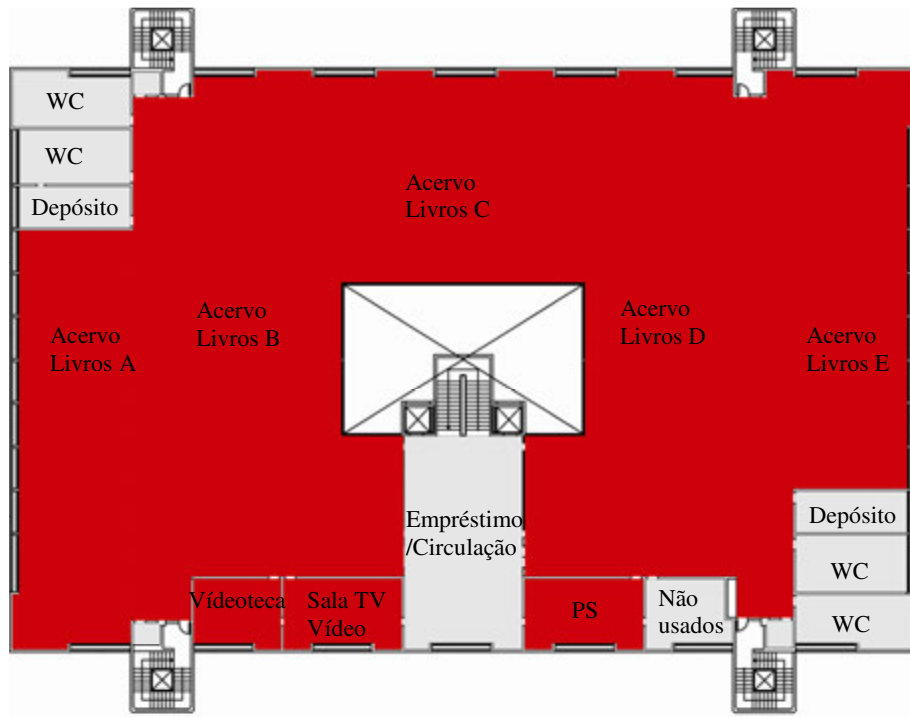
Planta baixa esquemática do segundo pavimento.
